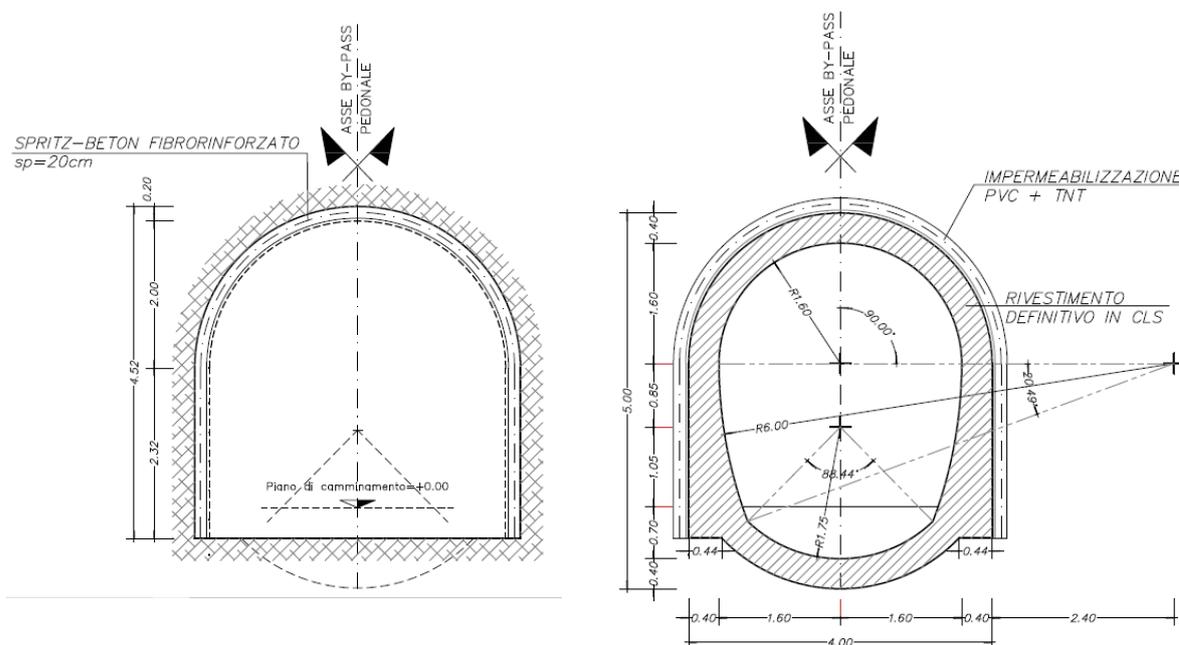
Sezione tipo di avanzamento e carpenteria By-Pass Pedonale
